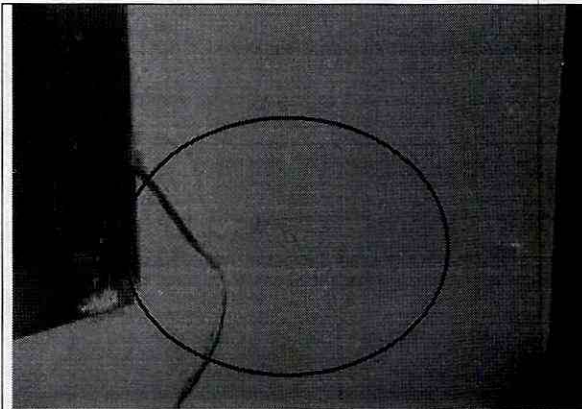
Fisuras en muros de primer piso, costado occidental
